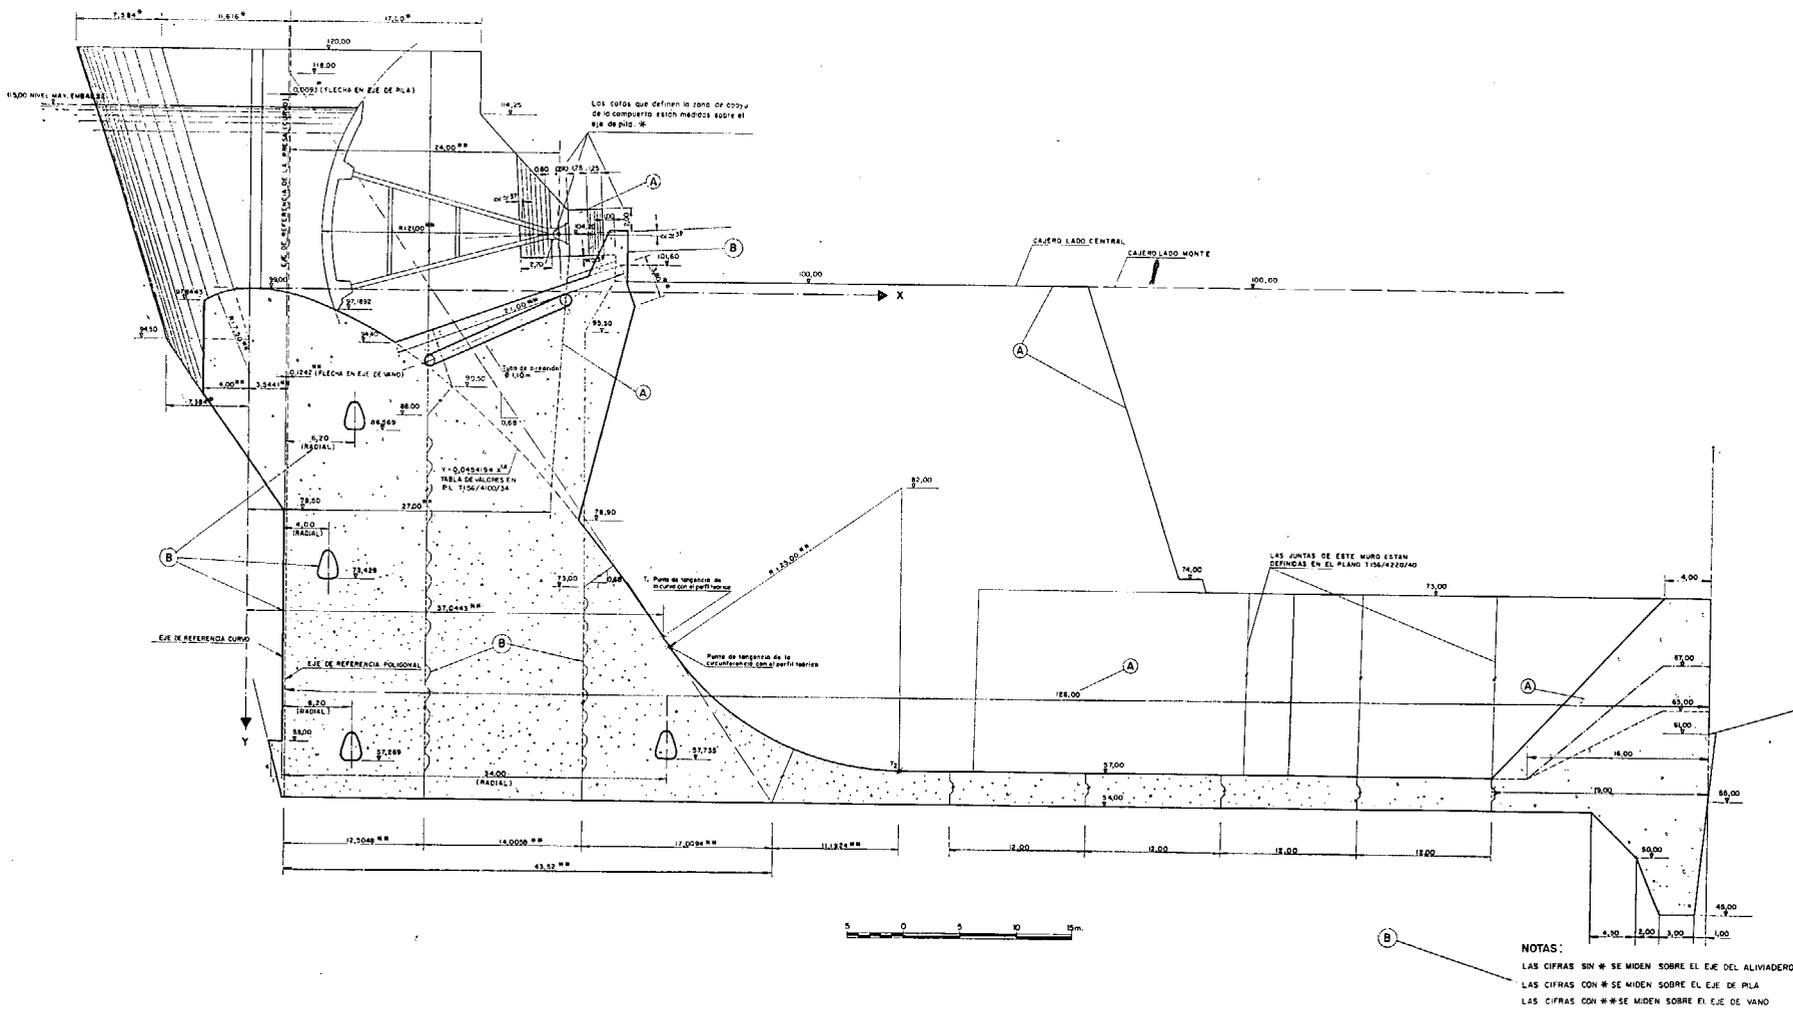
Aliviadero del Tajo. Perfil longitudinal por eje de vertedero.
